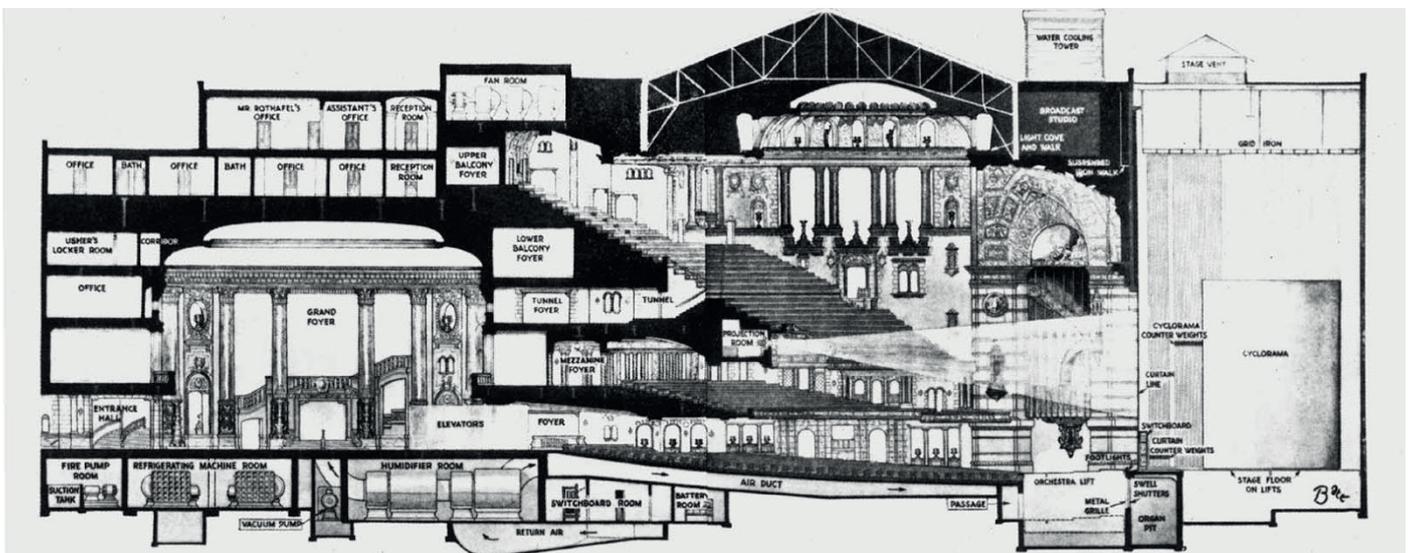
Roxy Theatre - coupe - Walter W. Ahlschlager - New York - 1927
